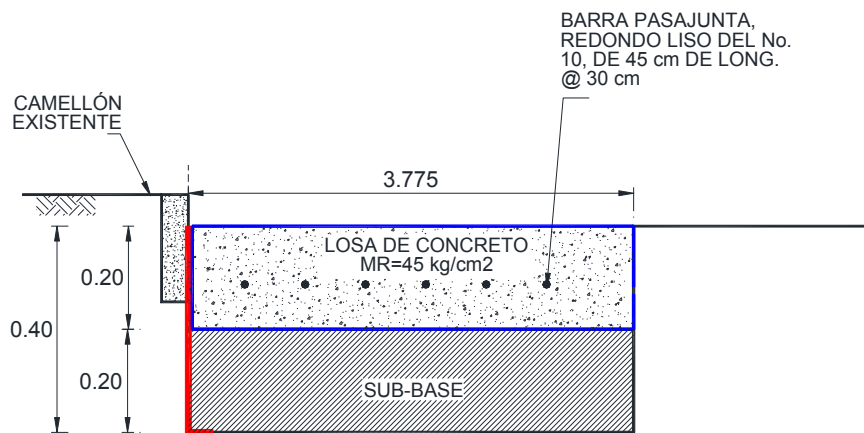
Construcción de losa de concreto hidráulico con juntas
